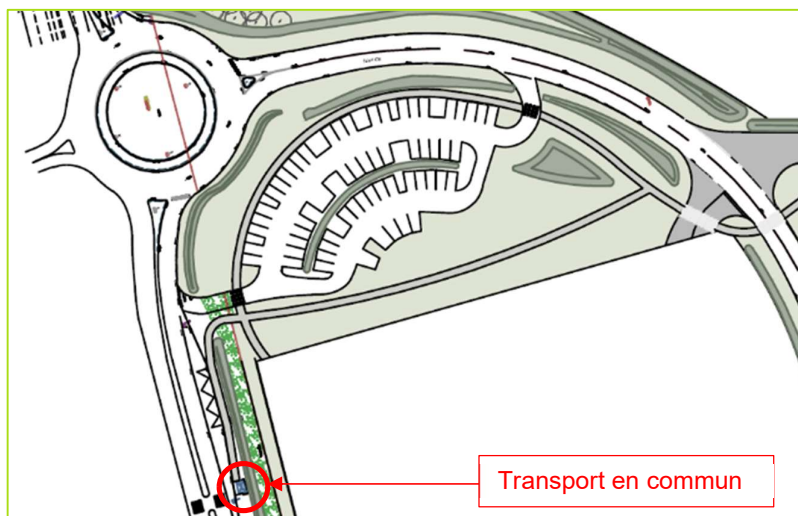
Circulations douces au droit de l'aire de covoiturage (Source : SUEZ Consulting)
